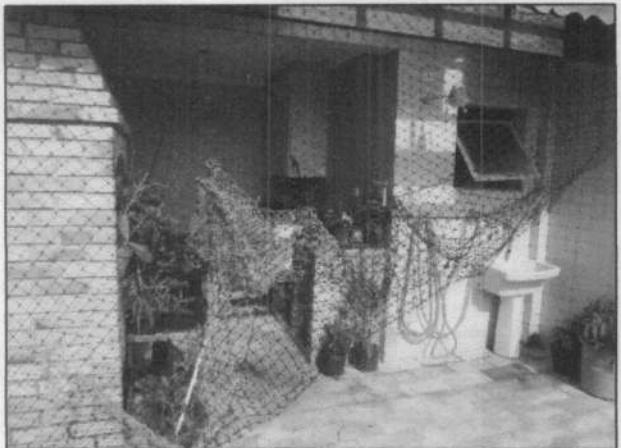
, 07 e 08 – Vista da Cozinha, área de serviço e banheiro.
